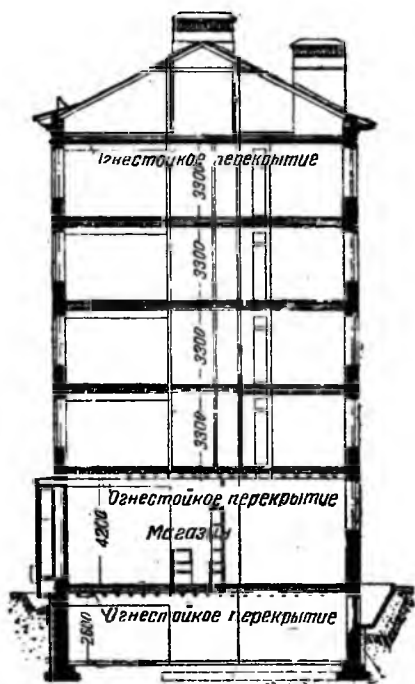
Расположение огнестойких перекрытий в жилом доме
